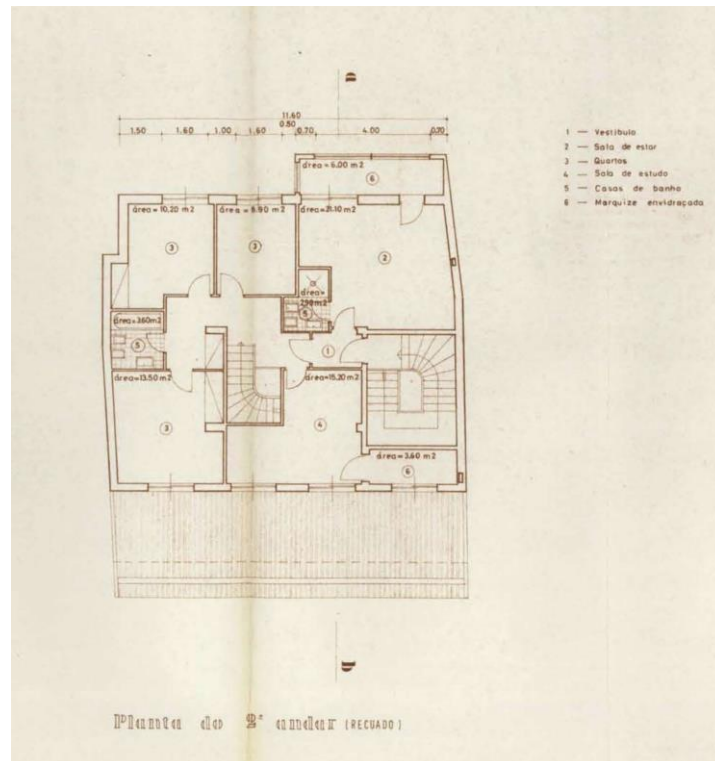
Planta de Levantamento, 2º Piso, fonte Câmara Municipal de Leiria
